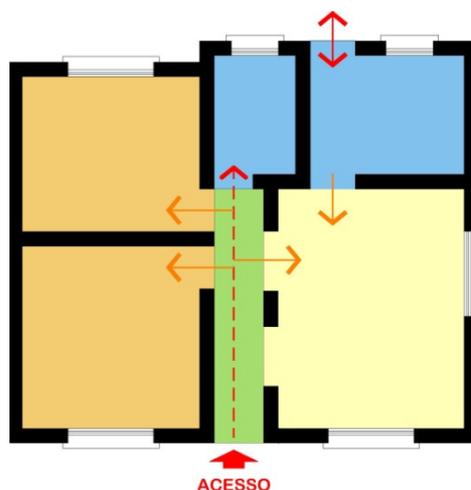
Planta esquemática com a setorização funcional e fluxos de circulação
